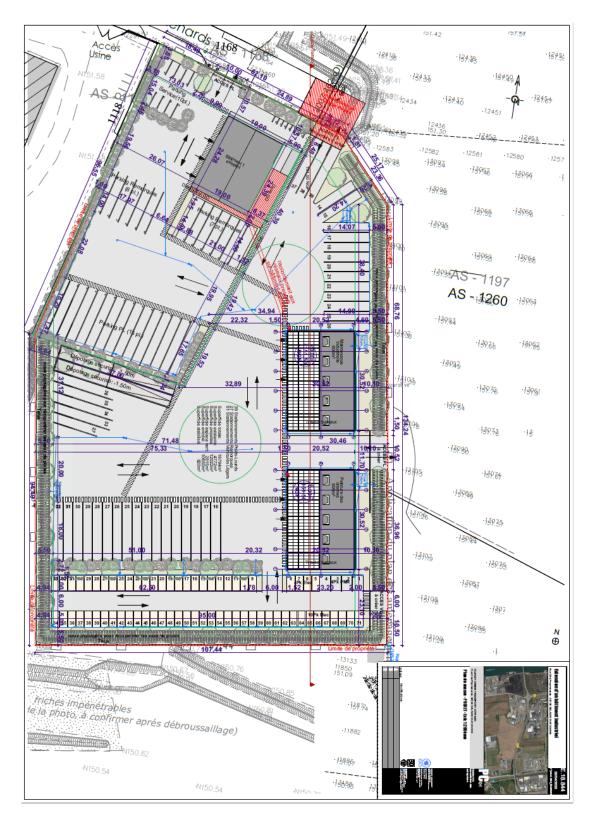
Plan Masse du Permis de Construire de Cottard Glénat
